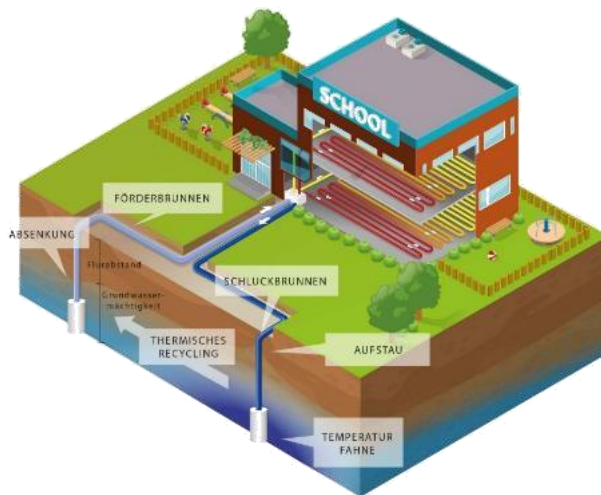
Der typische Aufbau einer Grundwasserwärmepumpe mit Förder- und Schluckbrunnen
